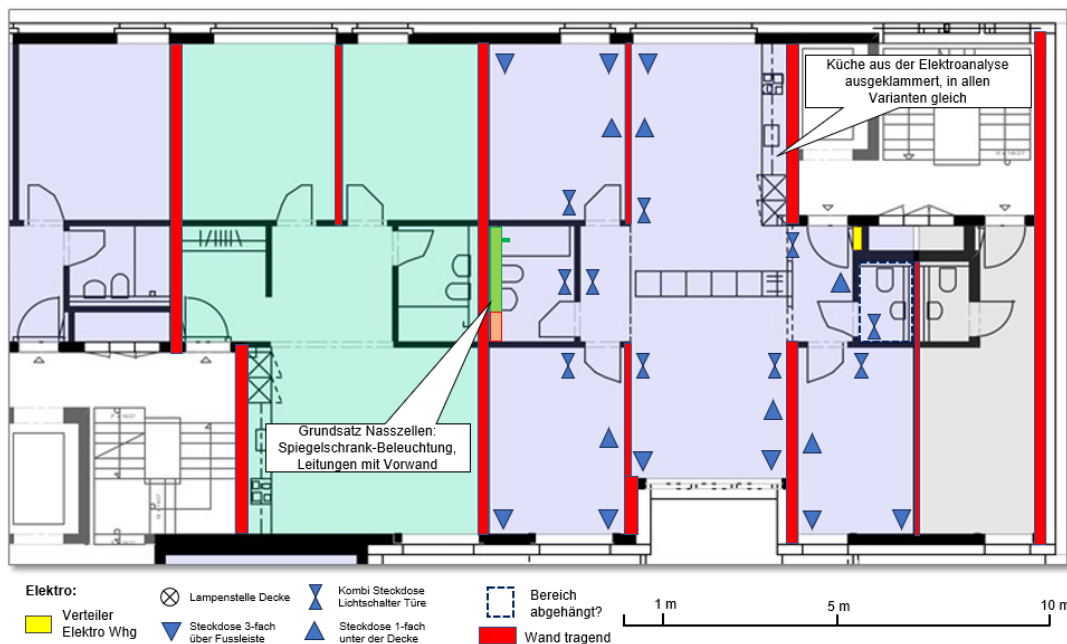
schematischer Grundriss zu den Variante 3 und 4 mit nicht im Beton eingelegter und an der Wand sichtbaren Elektroinstallationsausführung. Eingezeichnet sind die Wand-Steckdosen unmittelbar unterhalb der Decke für die Deckenlampen, Lichtschalter und Dreifach-Steckdosen in den Räumen (i.d.R. 20 cm über dem Boden).
